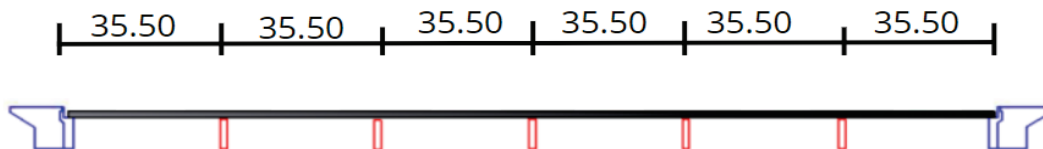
Coupe longitudinale de la 2^{ème} variante.
